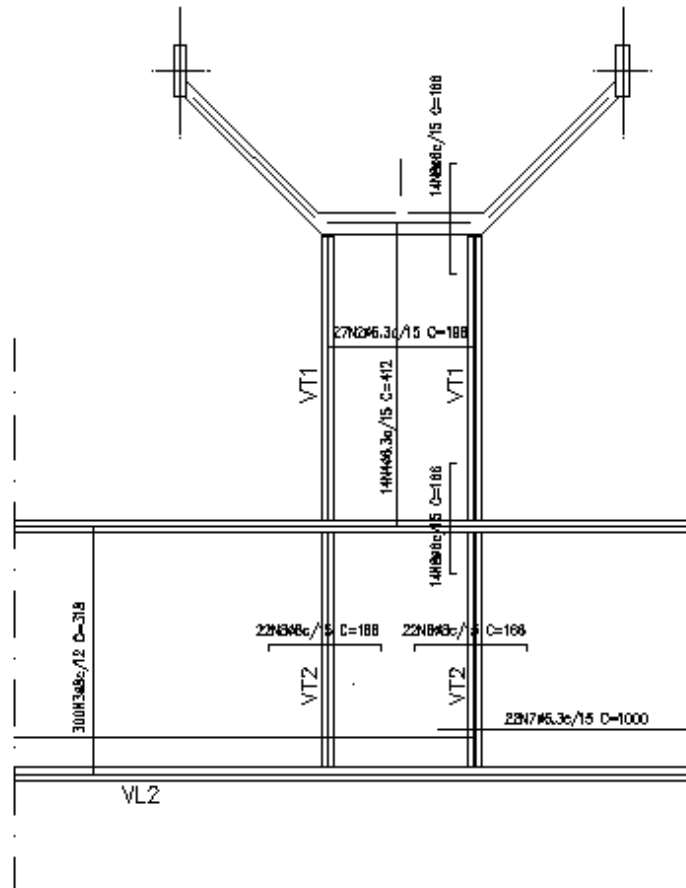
Detalhe das armaduras negativas das lajes da passarela
